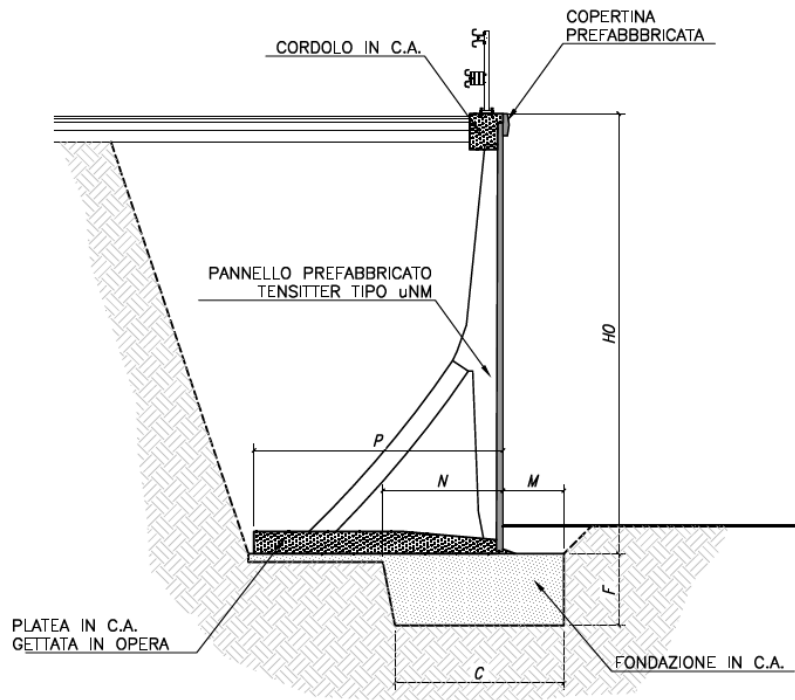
Sezione tipologica muro prefabbricato di tipo "uTM"
